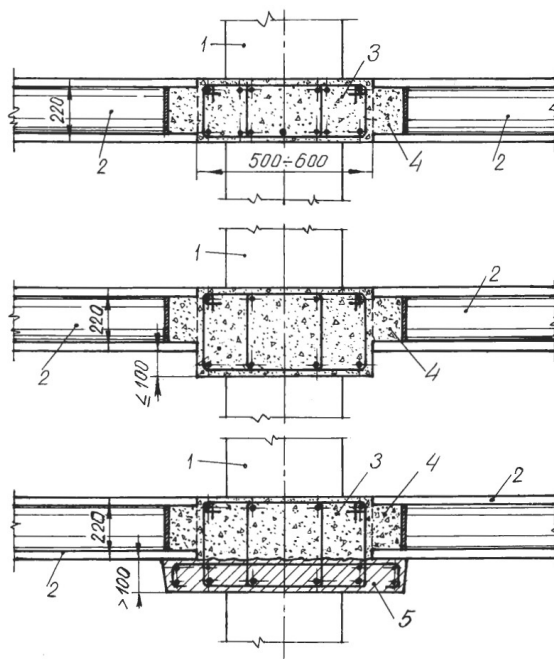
Конструкция несущих ригелей. а – монолитный ригель с высотой сечения на толщину пустотных плит (плоские перекрытия), б и в – соответственно, монолитный и сборно-монолитный ригели, выступающие книзу;
